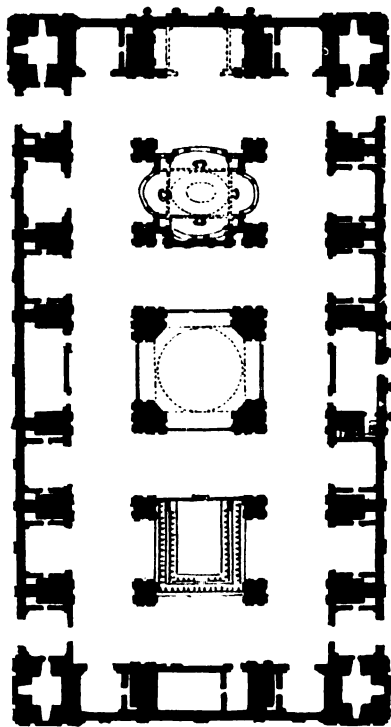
Grundriss von N. S. del Pilar zu Zaragossa (n. Fergusson).
